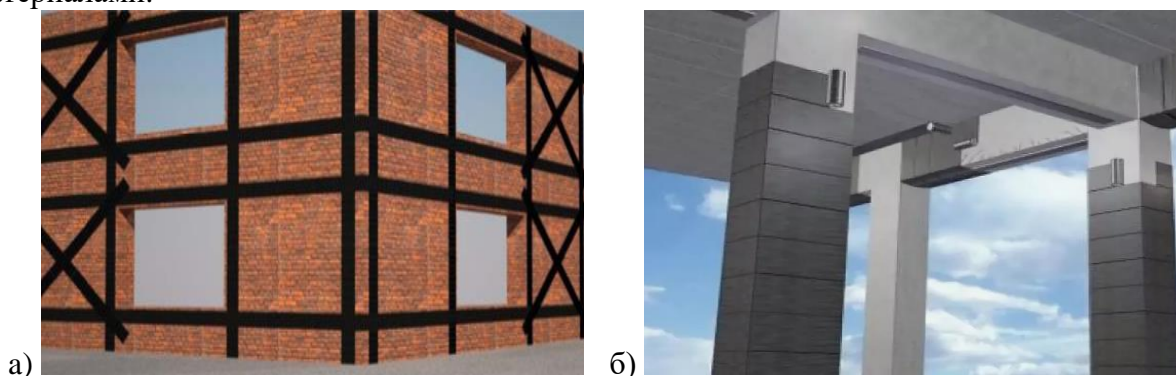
Внешнее армирование строительных конструкций ткаными композитными материалами: а) армирование кирпичных стен; б) армирование колонн
